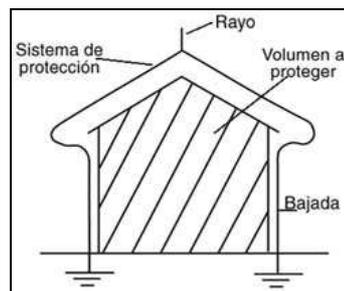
Sistema de protección no aislado de la estructura a proteger con su respectivo sistema de bajada.
